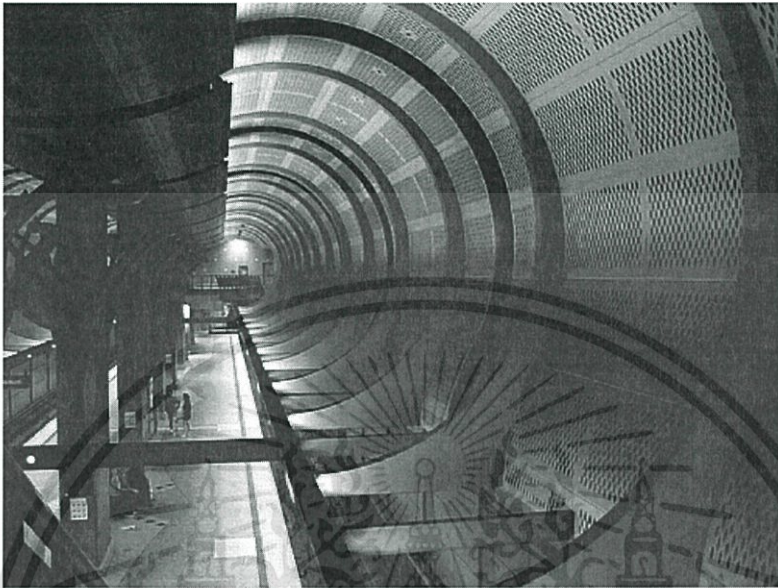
ผนังอุโมงค์ Los angeles metro มีระบบ Stabilization ที่ใช้ชิ้นส่วนผนังอุโมงค์ที่หล่อสำเร็จ (<http://www.streetsblog.org>)
